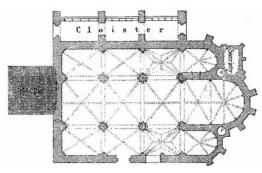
Valladolid. Iglesia de Santa María la Antigua, planta general (Street [1865] 1926)
